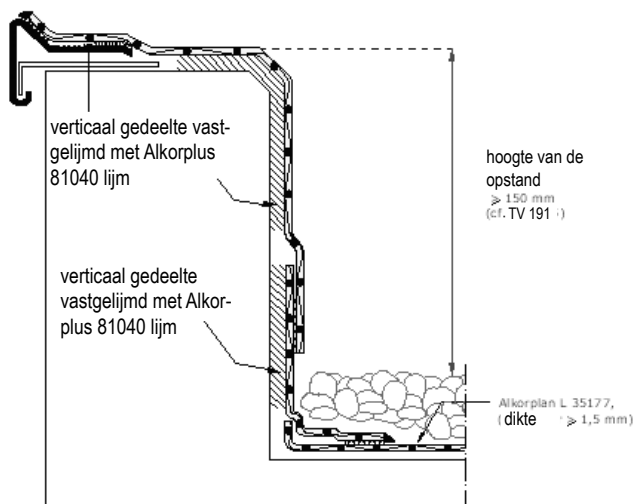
Typisch detail voor de opstand met Alkorplan® L van 1,5 mm dik (of dikker) zonder bedekking
